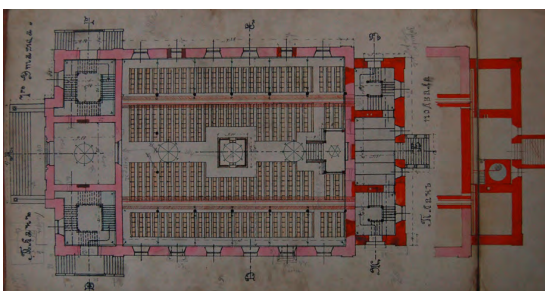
Planmaterial Grundriss Erdgeschoss
